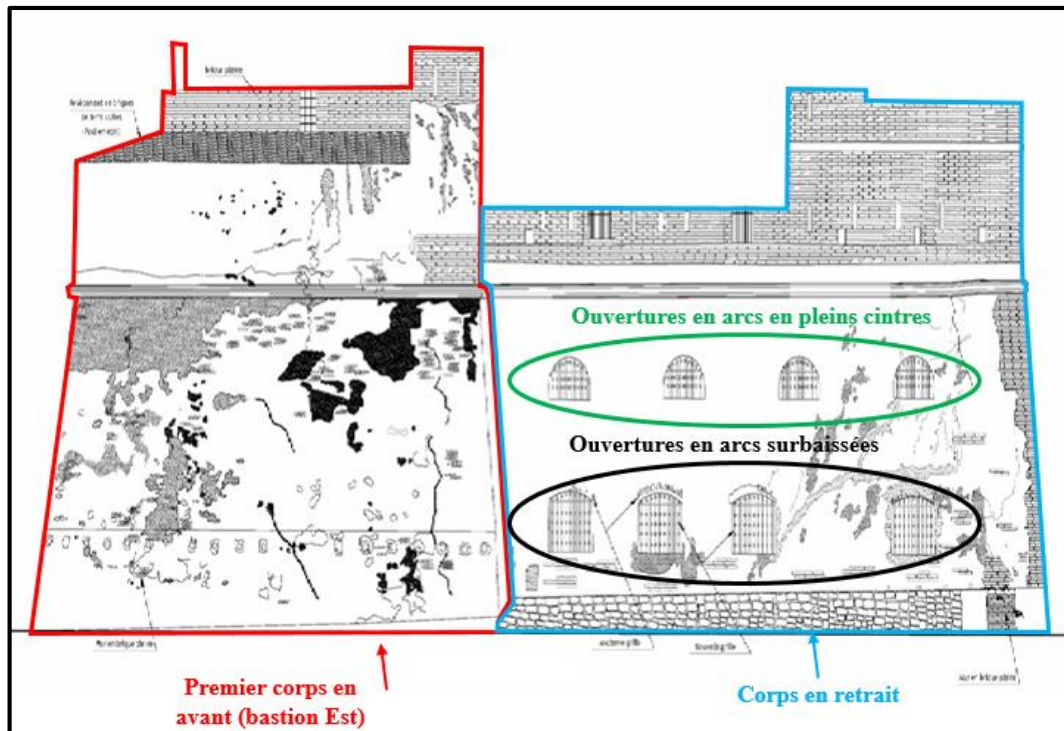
Façade Ouest de Bordj Moussa (Source : BET MAHINDAD, traitée par l'auteur 2025).
